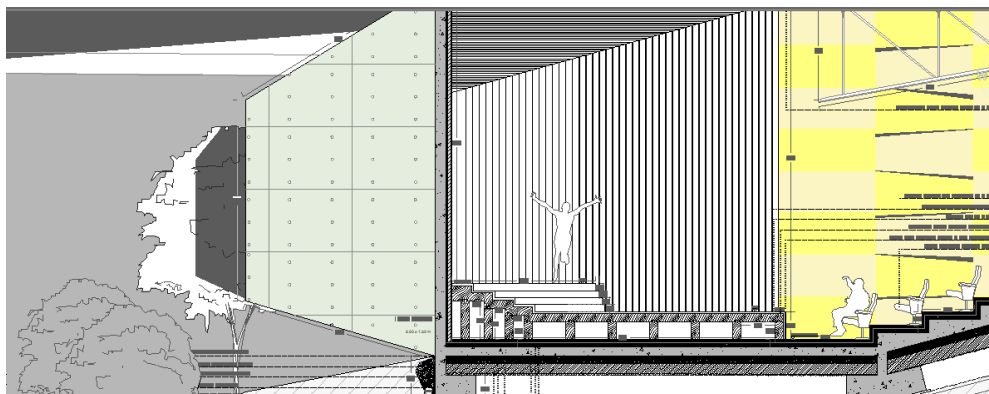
Corte Longitudinal para a proposta da Casa da Música (pormenorizado)
